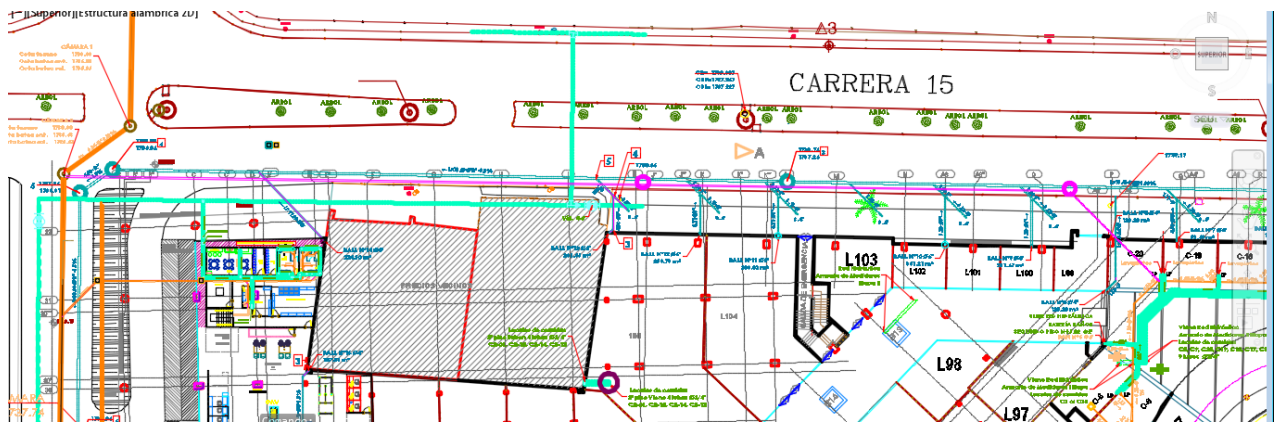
Vista en planta, alcantarillado sanitario. (Fuente: Diseño ARINSA)
